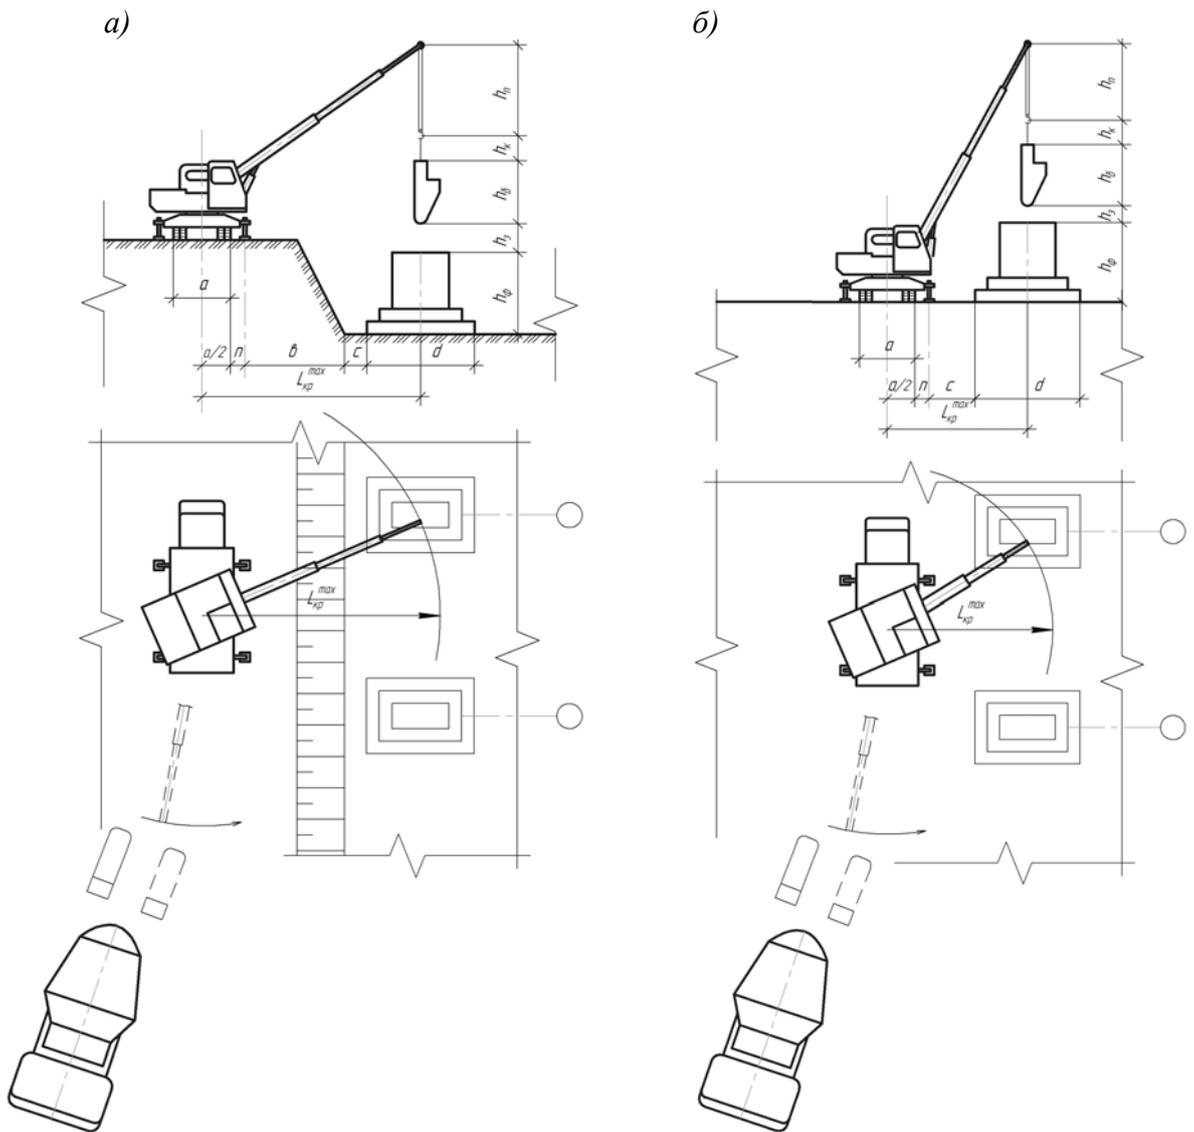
Схема бетонирования фундаментов по схеме «кран – бункер»: а – кран располагается на бровке; б – кран располагается в котловане
